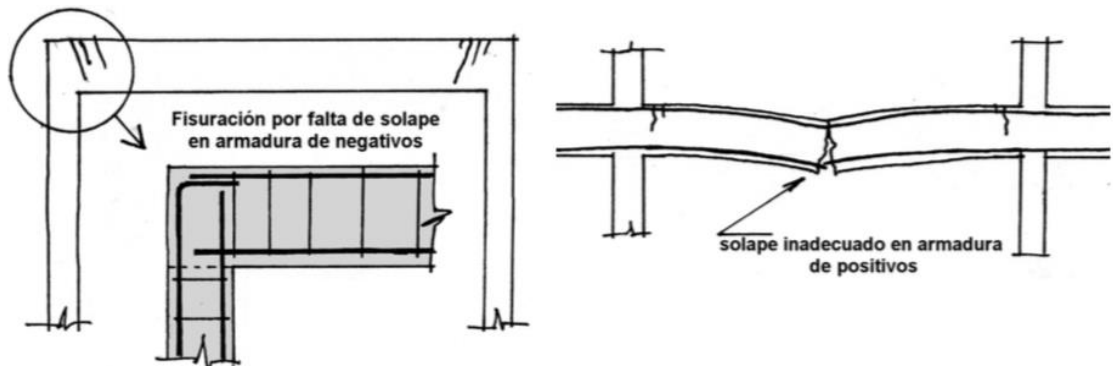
Detalles de fisuración por solape inadecuado. Fuente: Rodríguez, et al., 2004.
